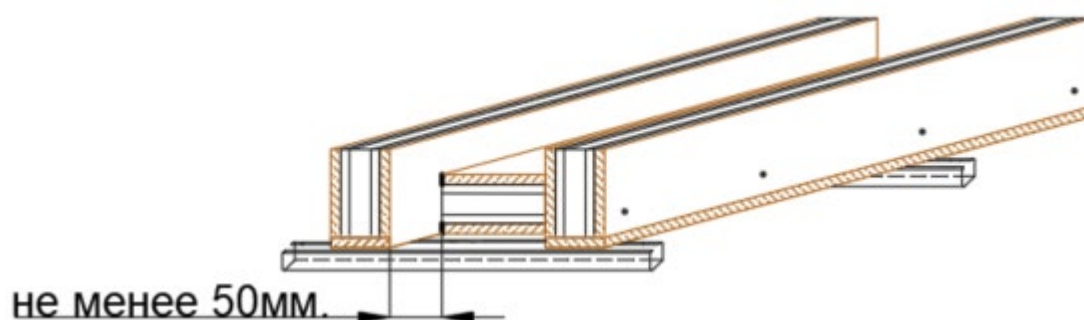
Сборка днища и боковых стенок короба-лотка со смещением
